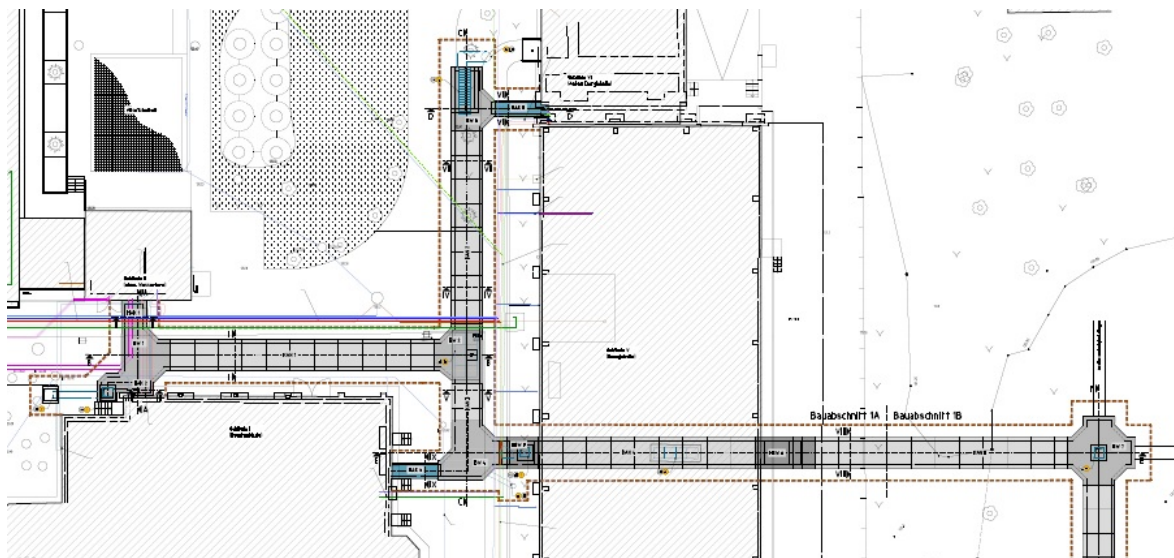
Detaillierter Lageplanausschnitt Trassenabschnitt 1A
